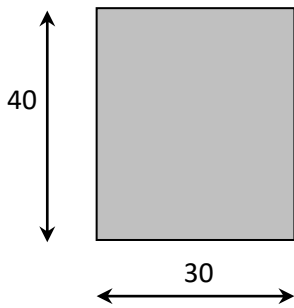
Dimensions de la poutre principale. Figure II-5 : Dimensions de la poutre secondaire.
